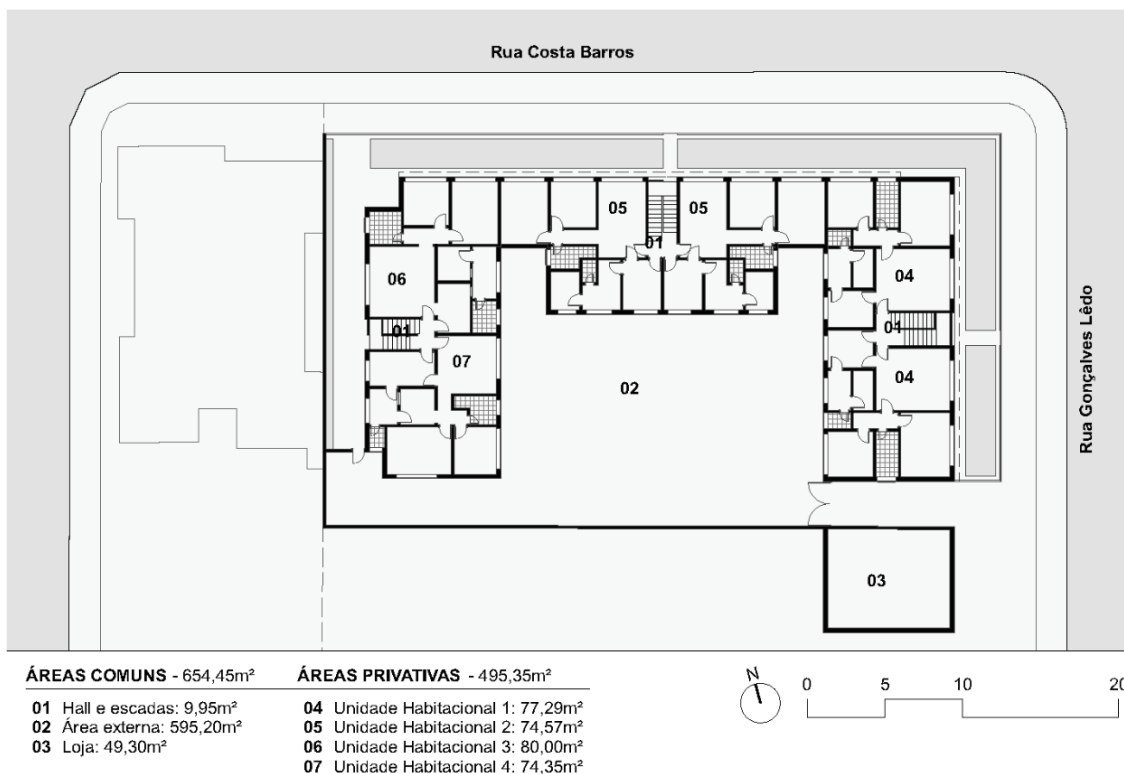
Planta do pavimento tipo do Edifício Don Inácio. Fonte: Elaborada pelos Autores a partir de Cavalcante (2015).
